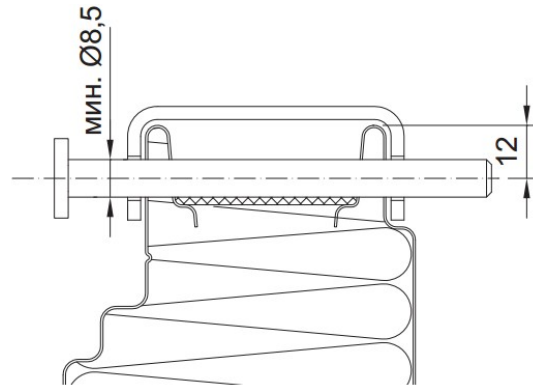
Использование швеллерной накладки при горизонтальной укладке.
